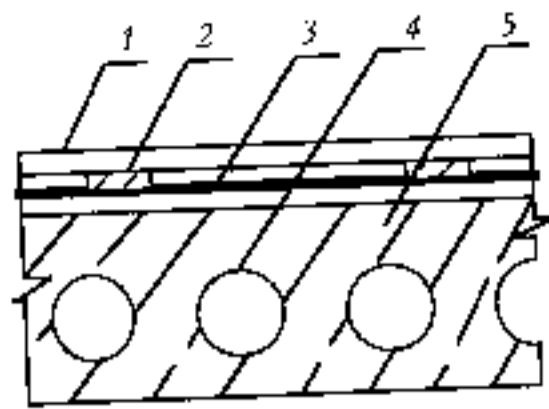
1 - доски пола; 2 - лаги; 3 - звукоизоляционные маты; 4 - выравнивающий слой (цементный раствор); 5 - железобетонная плита перекрытия
